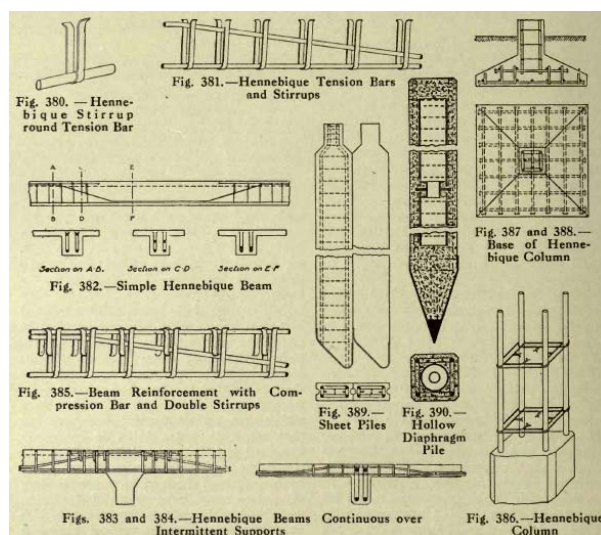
Detalhes de vários elementos estruturais do sistema construtivo em betão armado desenvolvido por François Hennebique, adaptado de (Jones, 1913).
